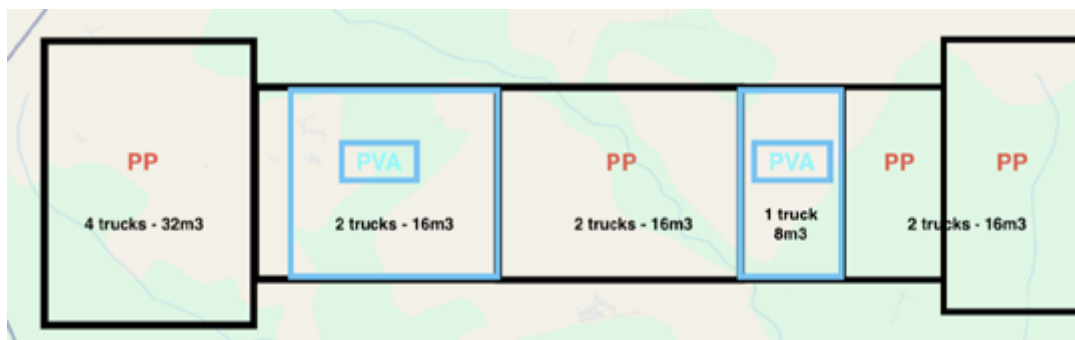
Configuração final das fibras na pista da praça de pedágio.
